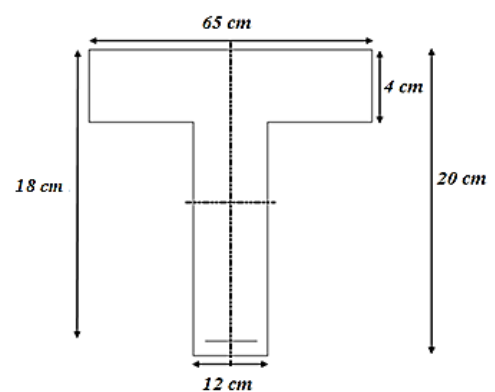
Section de la poutrelle après coulage de la dalle de compression.
